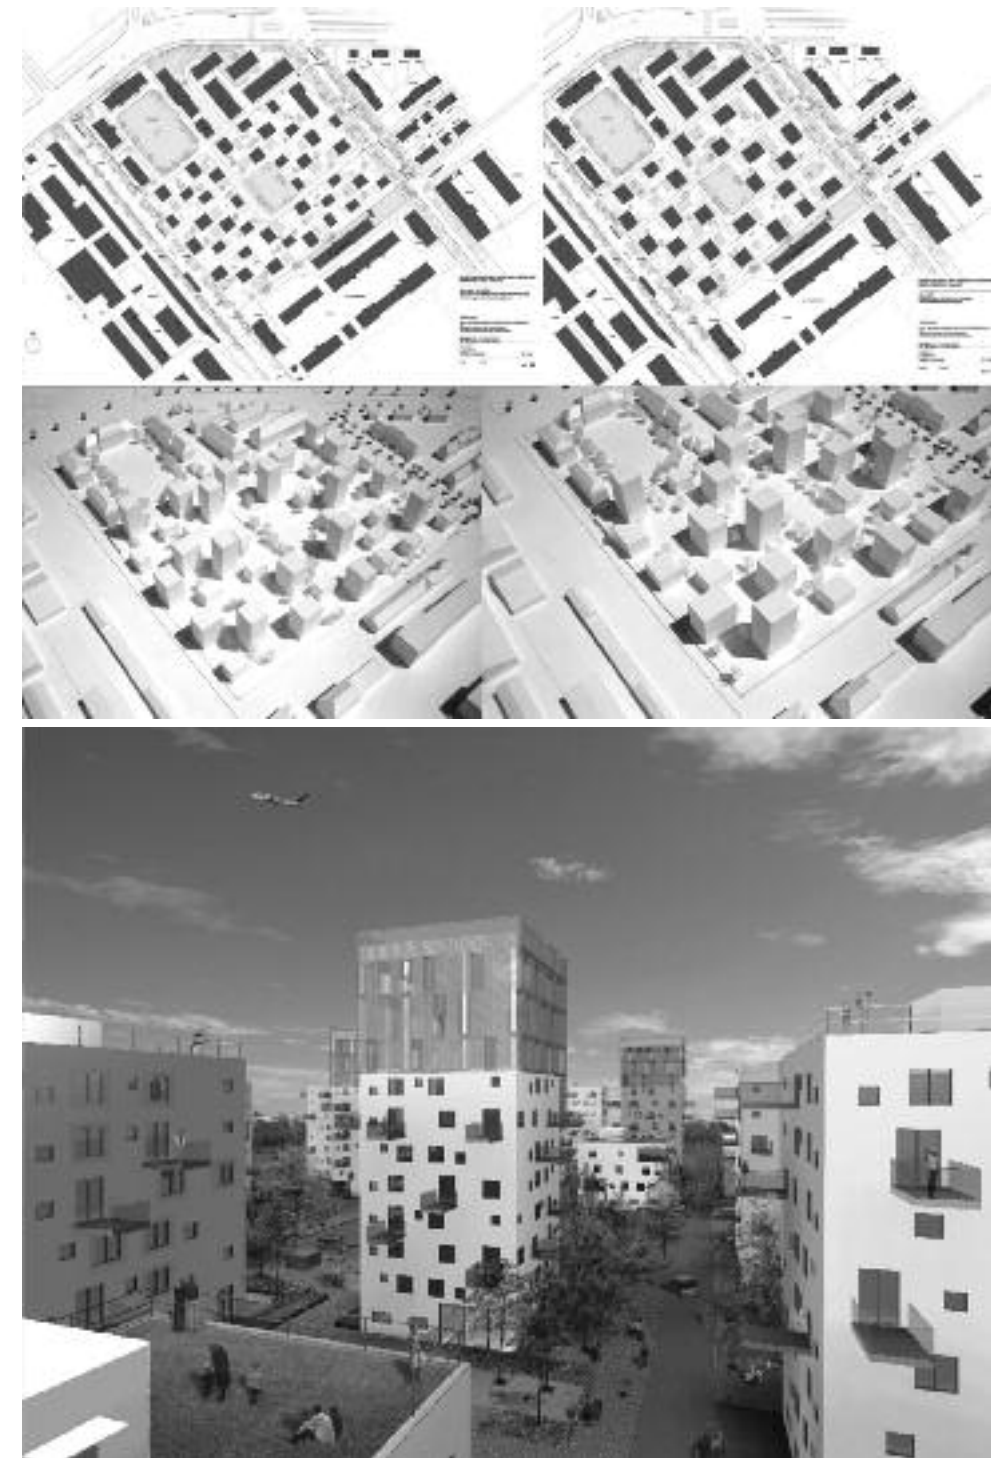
Lageplanvergleich für München-Wiesefeld: Wettbewerb und Stadtratsvorlage
